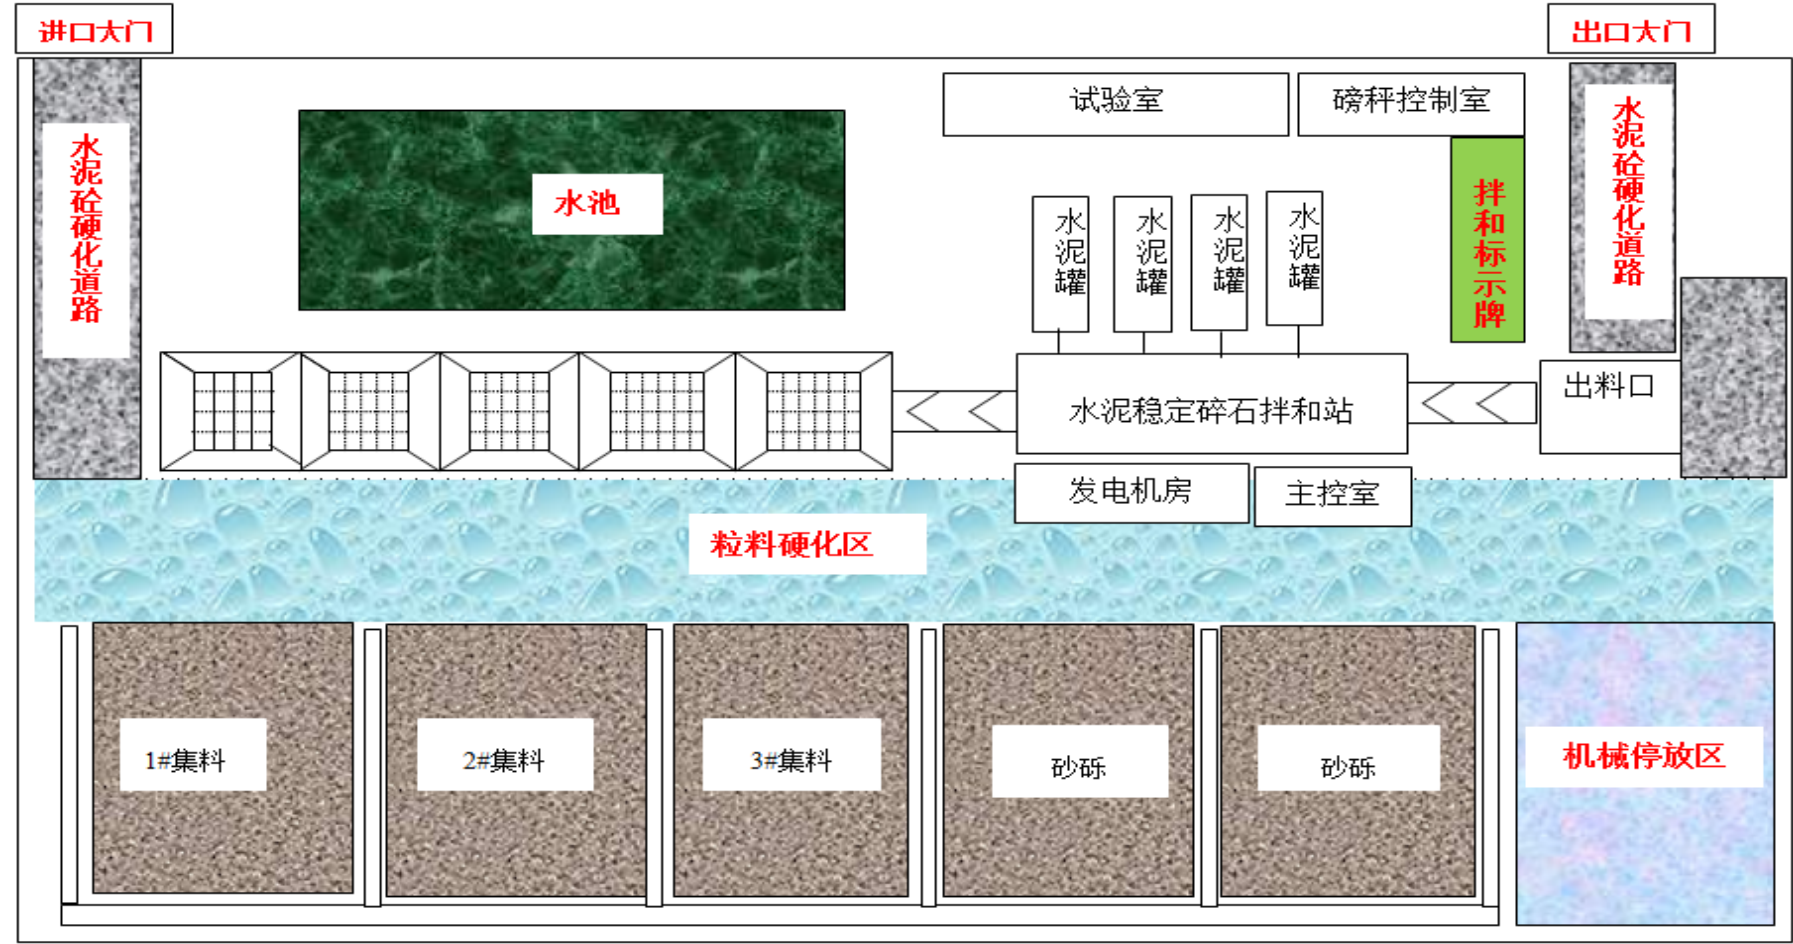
2. 2-3 稳定类拌和站场区平面布置图
